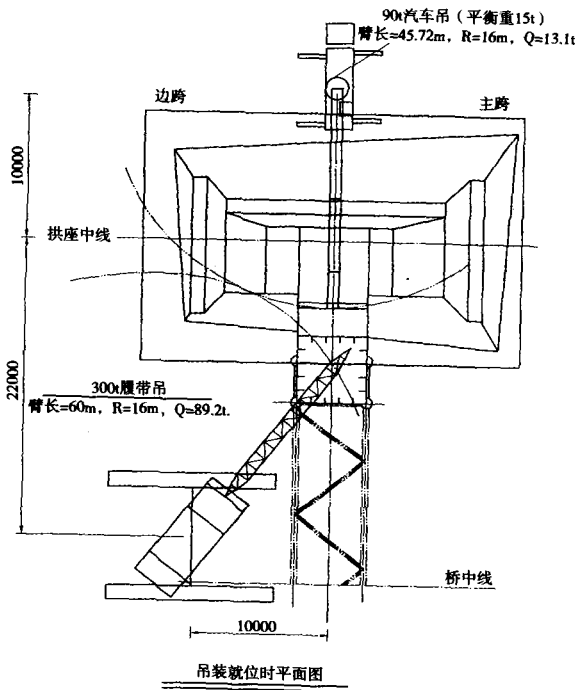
卢浦大桥大型履带安装主跨钢柱(尺寸单位:mm)
